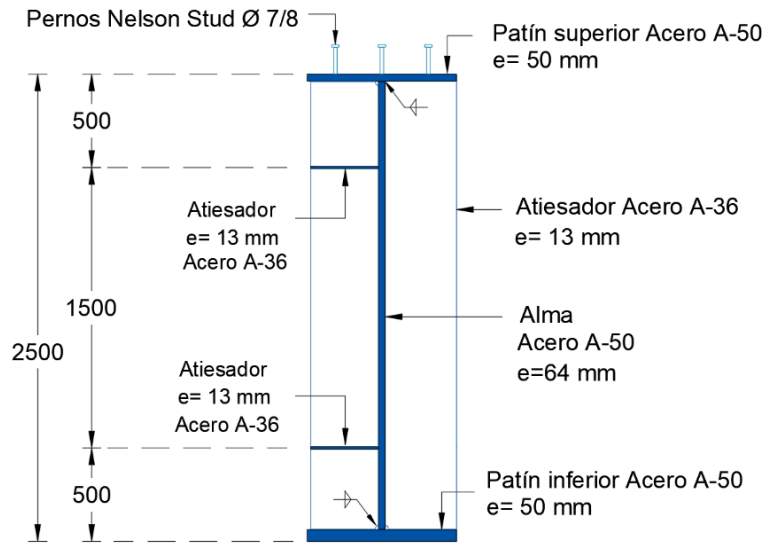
Sección transversal de trabe principal. Fuente: Elaboración propia
